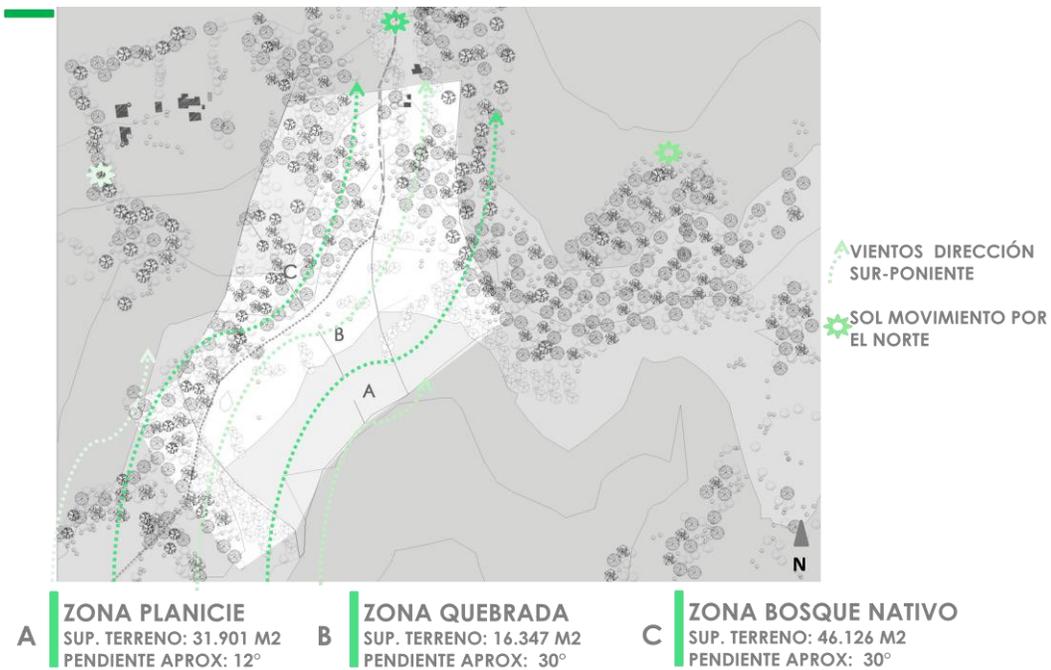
Zonificación planta terreno. Elaboración propia
